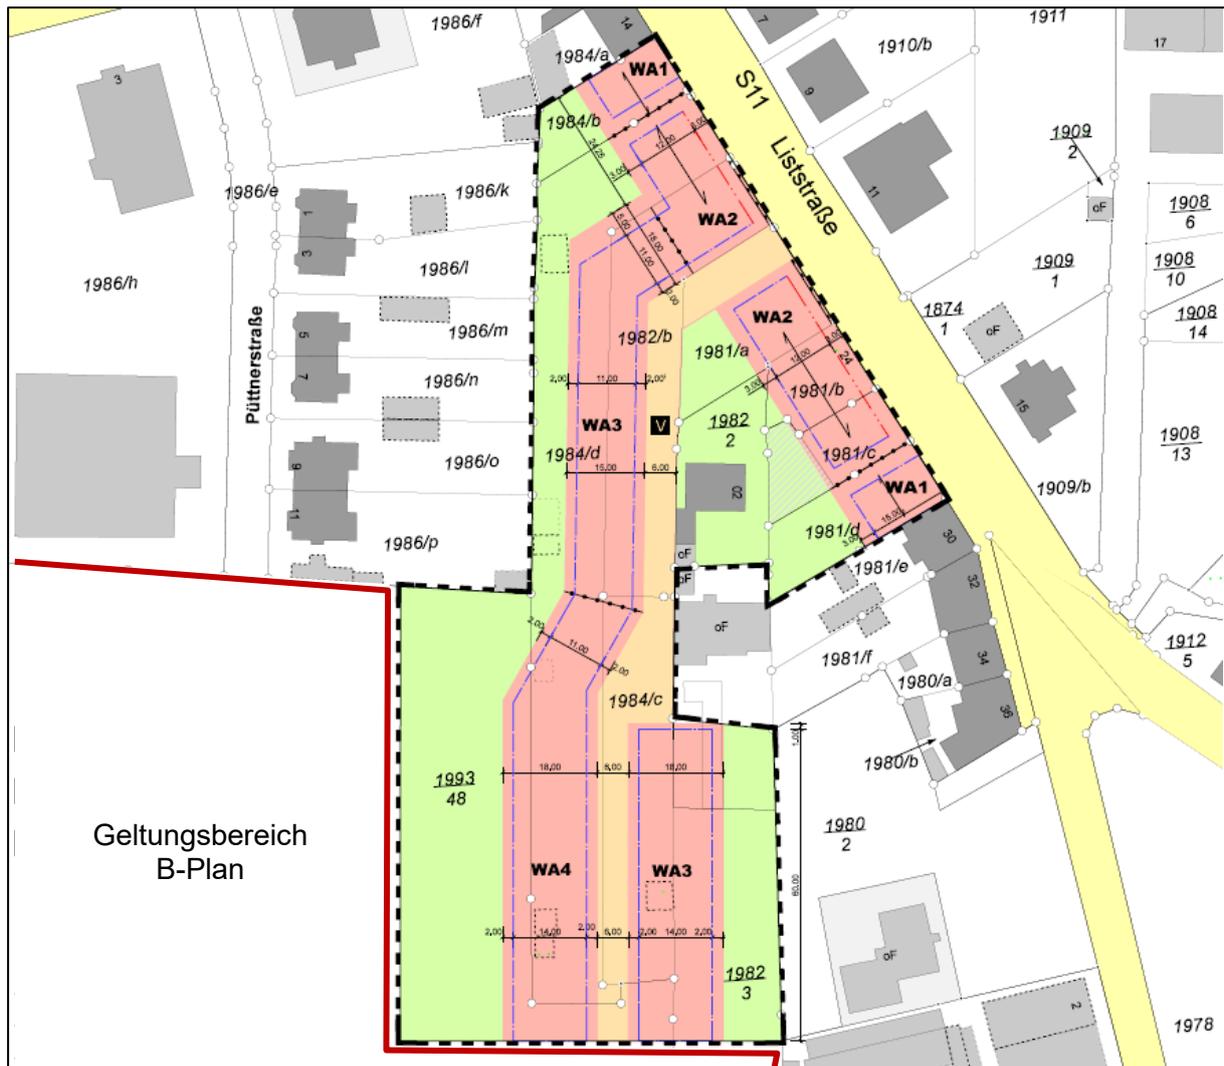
Auszug aus dem B-Plan „Wohngebiet I – Liststraße“
